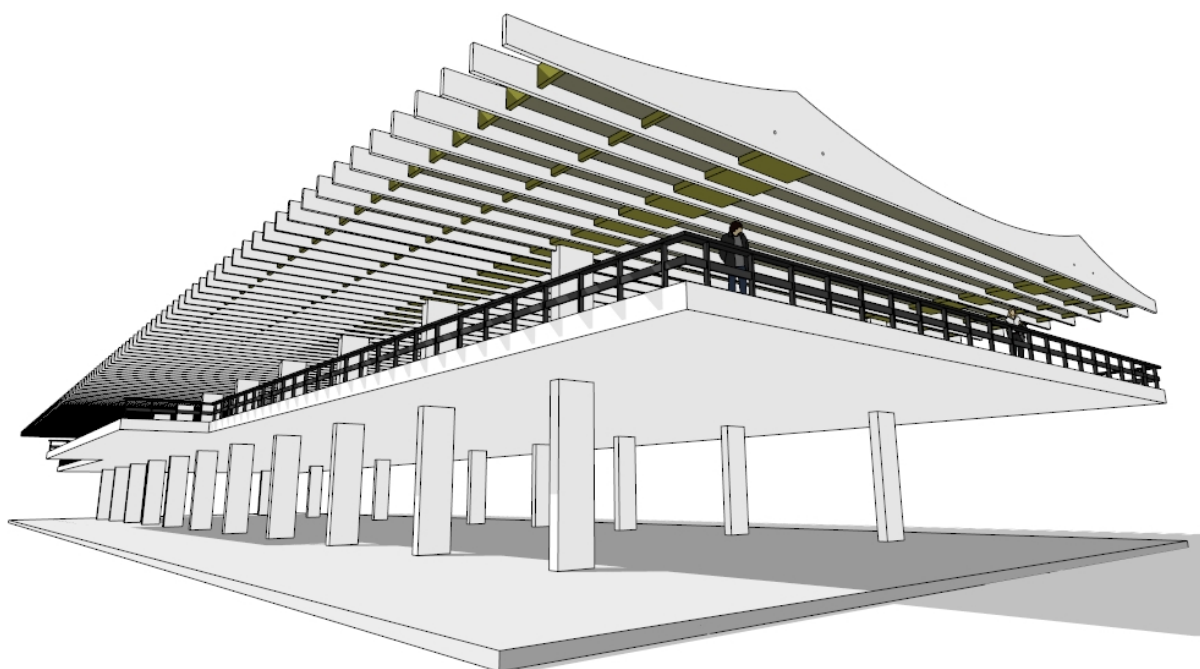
Detalhe dos pilares, vigas mestras e vigas transversais.
